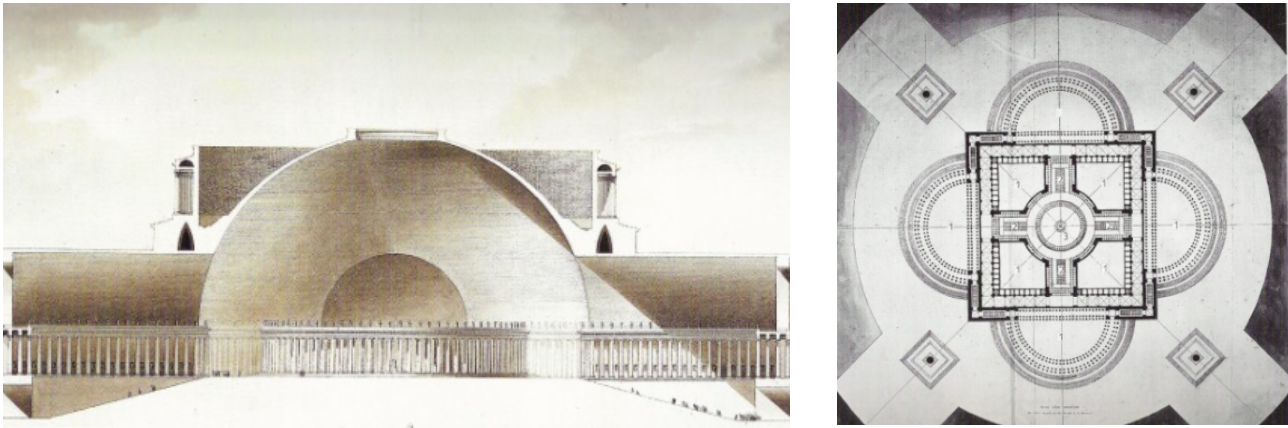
y 28: Alzado y planta del museo imaginado por Boullé.
